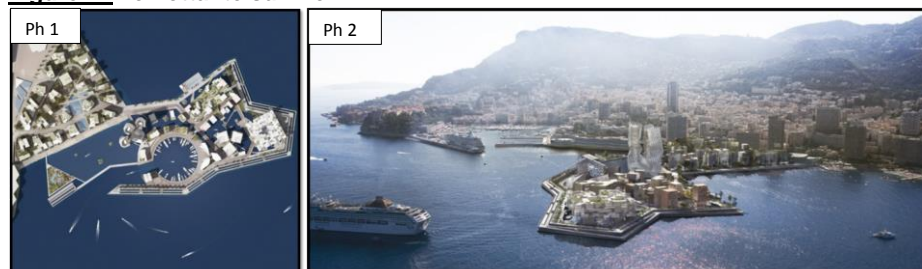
,2 : Ile construite sur la mer indépendante de l'existant. Cas de Monaco (France).
